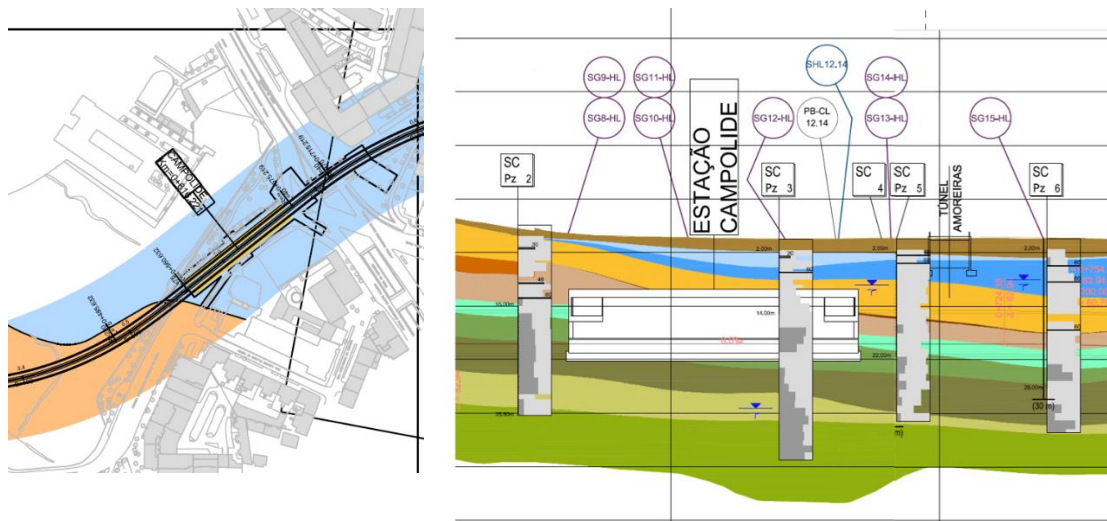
Planta e perfil longitudinal – Geologia / Geotecnia
